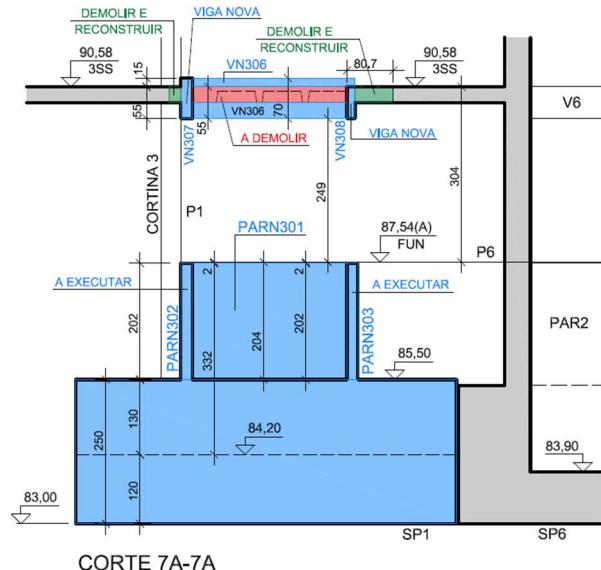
Detalhe de elevação da nova fundação no 4ºSS e das alvenarias, até atingir a laje do 3ºSS.
